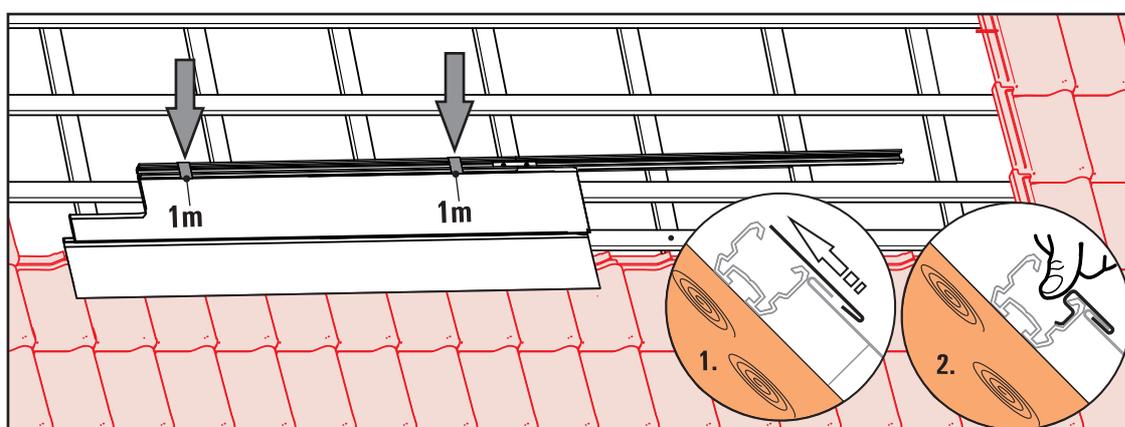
Fissare la lamiera di copertura sinistra (1g) con le lamiere di sicurezza (1m) (agganciare la lamiera di copertura dal basso e piegare il bordo del profilo di montaggio verso l'interno).
